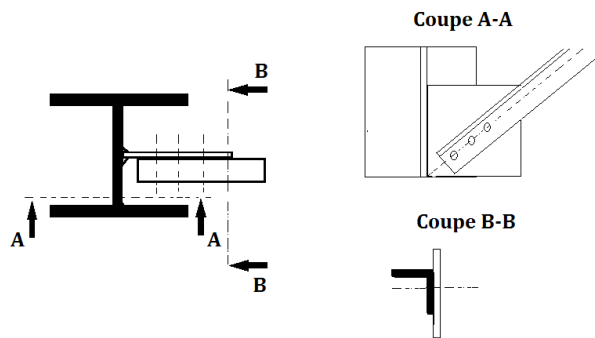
Assemblage de contreventement dans l'âme du poteau.
